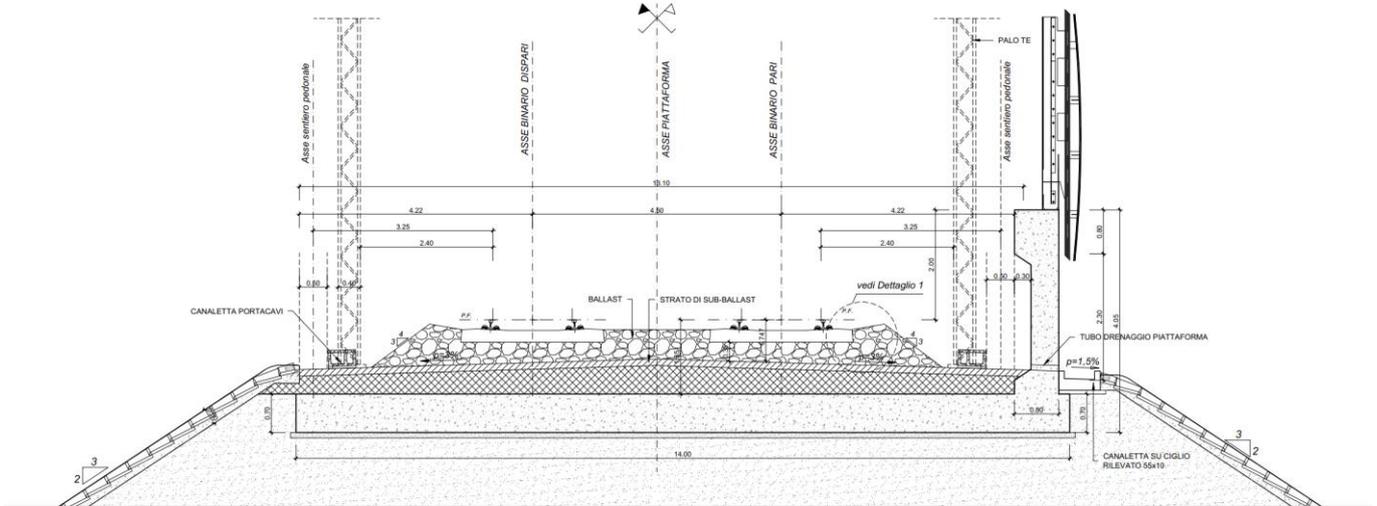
Sezione tipo in rilevato a doppio binario con muro di recinzione (tipo R01-B) con barriera antirumore
